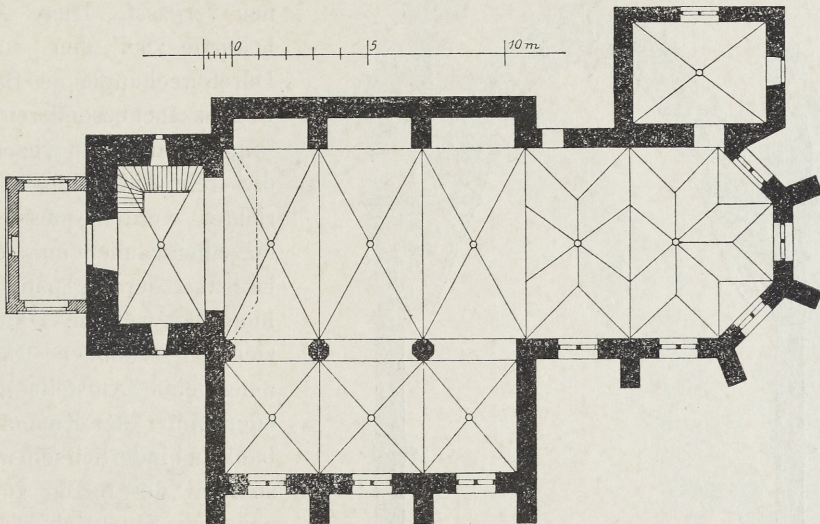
Siersdorf. Grundriss der kath. Pfarrkirche.
